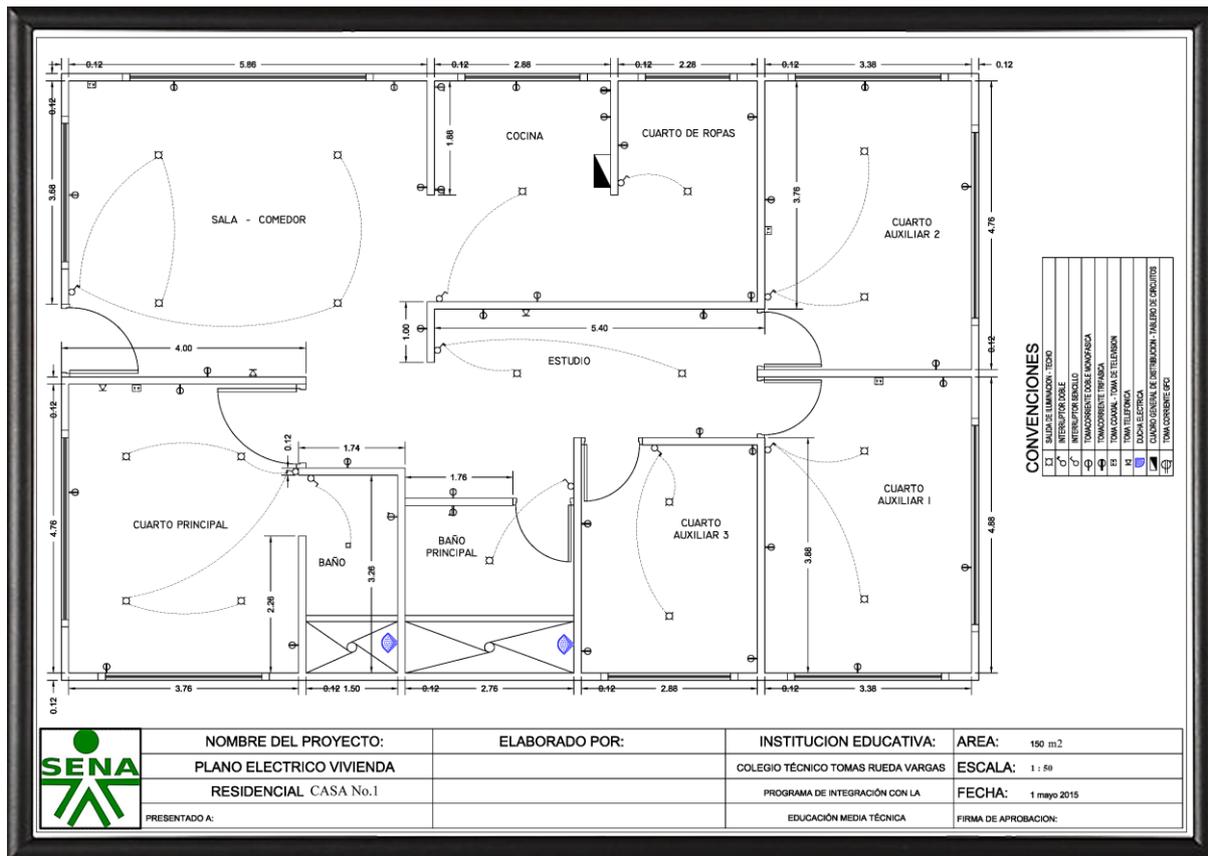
Plano arquitectónico y eléctrico de la vivienda uno.
